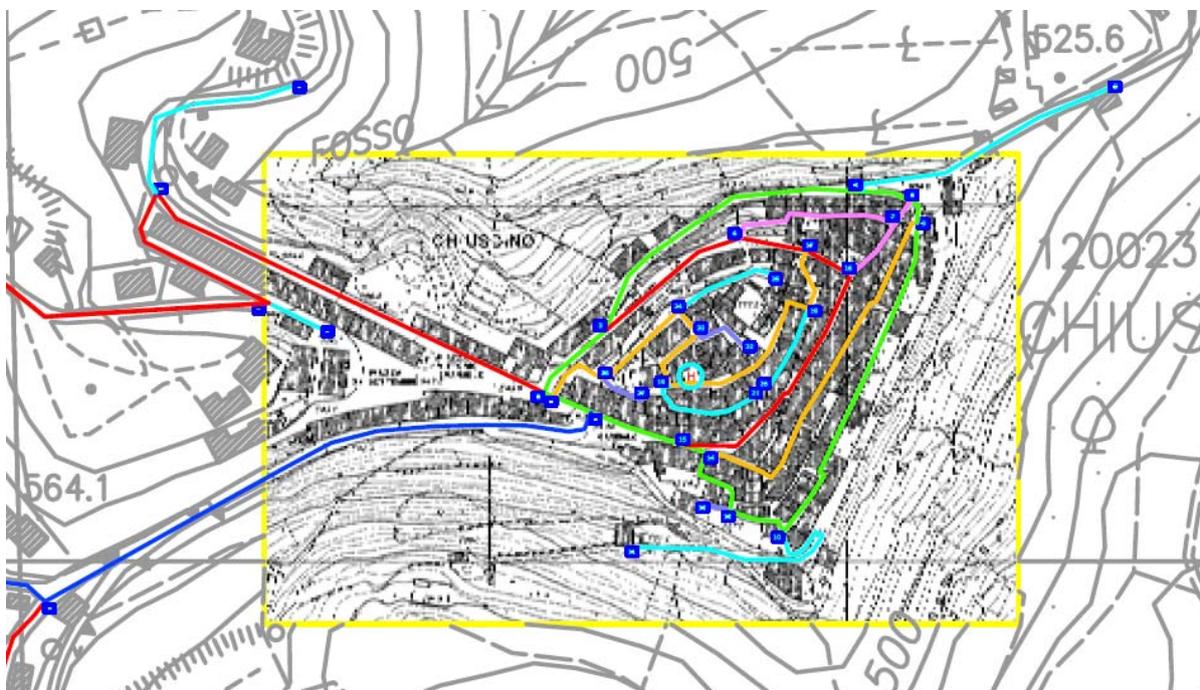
Dettaglio planimetrico rete di teleriscaldamento – tratto acqua calda
